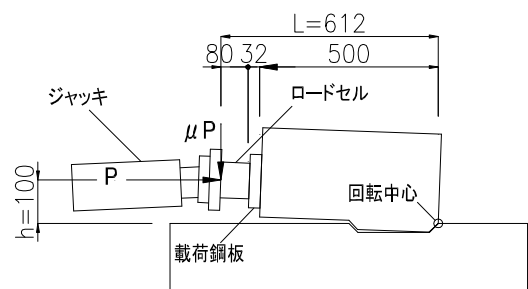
ひび割れ後の作用力 (単位:mm)
